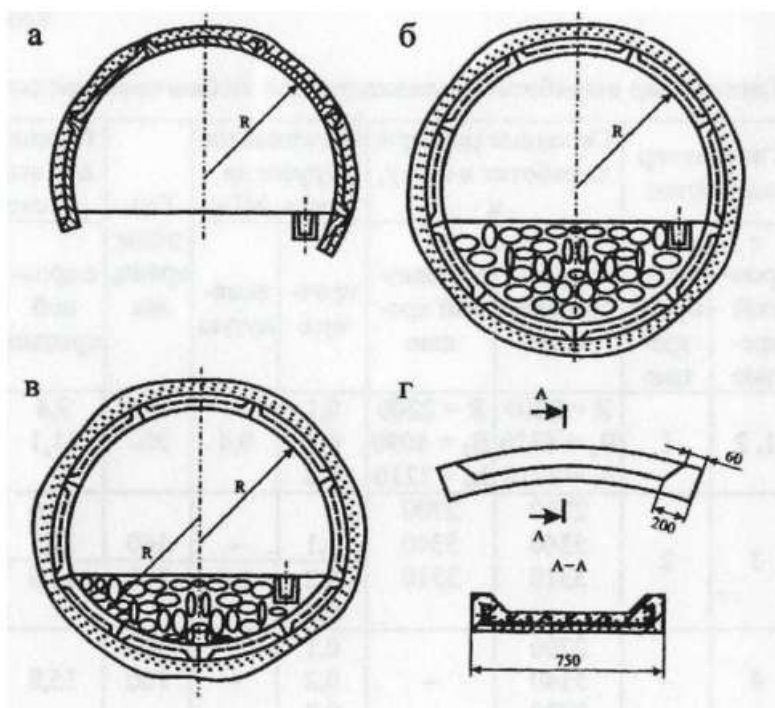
Железобетонная гладкостенная тубинговая крепь ГТК
